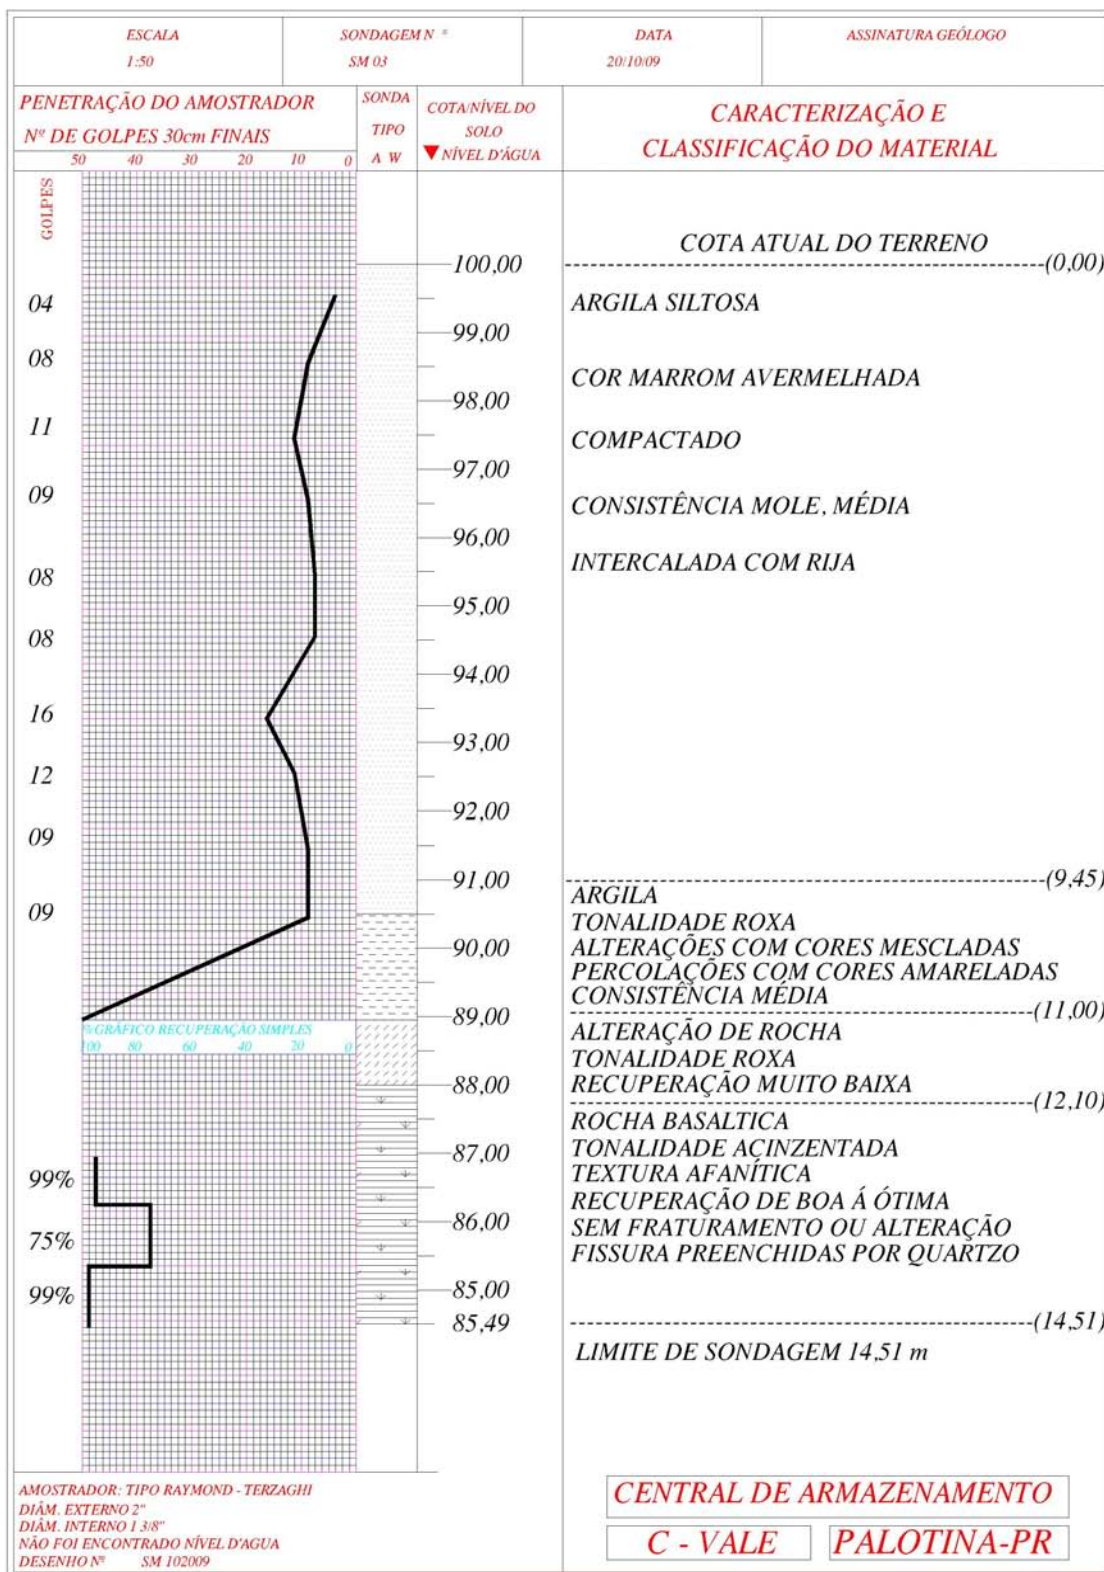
Perfil Sondagem Mista (SM) furo 03.
